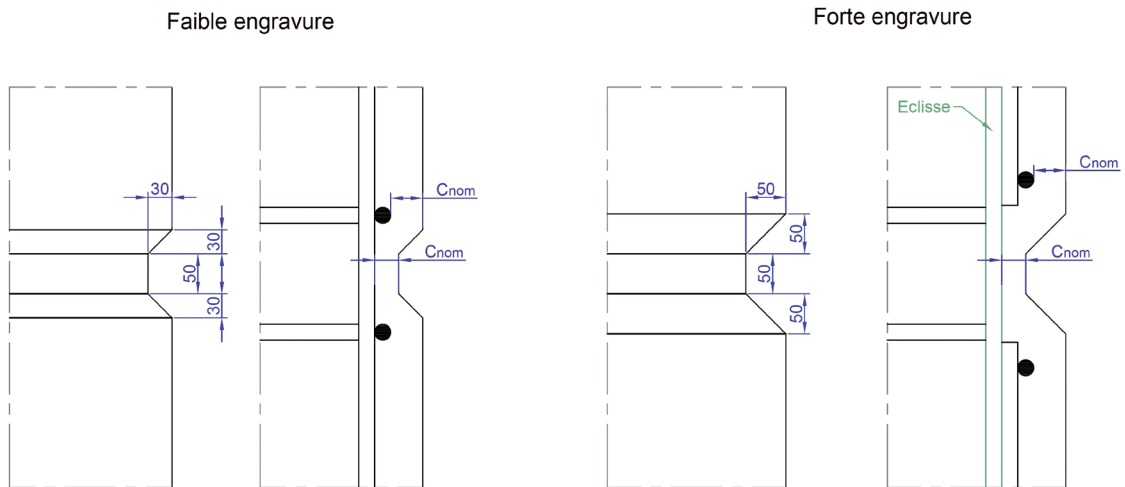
Mise en place du ferrailage dans une pièce avec engravure – 3
